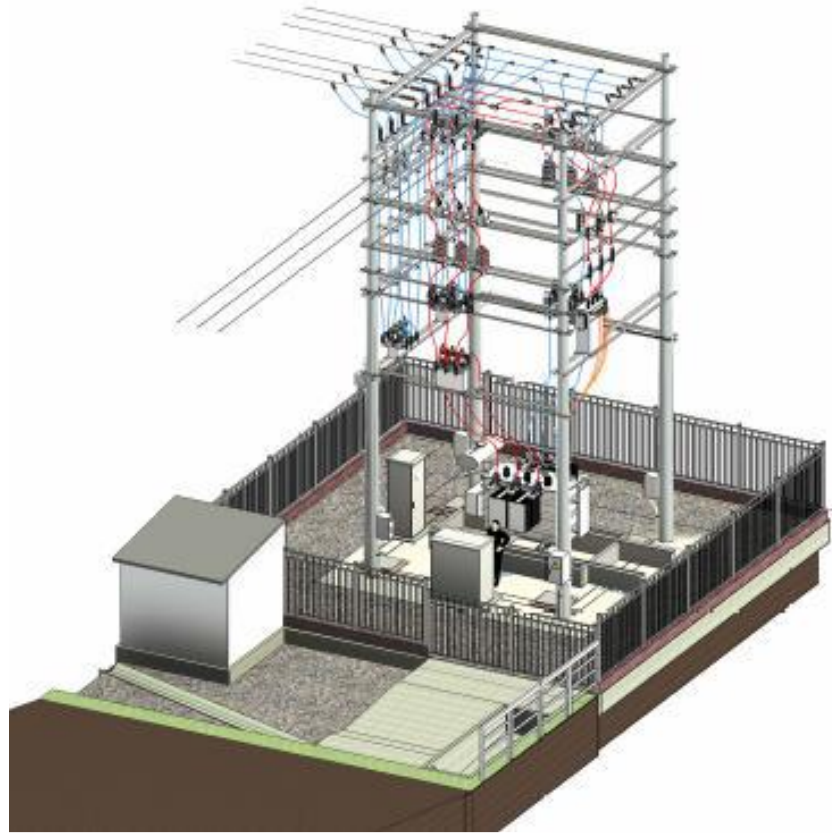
Inspección de fichas técnicas de los equipos y toma de dimensiones geométricas
